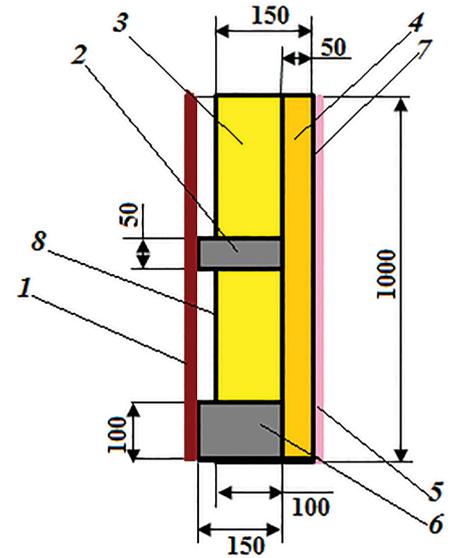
Схема каркасной стены с утеплением плитами на основе минеральной ваты:
